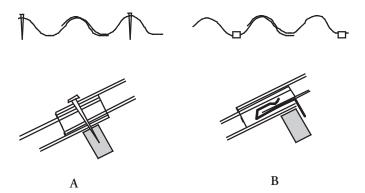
Fijaciones para planchas de asbesto cemento. A: Tornillo. B: Gancho.
